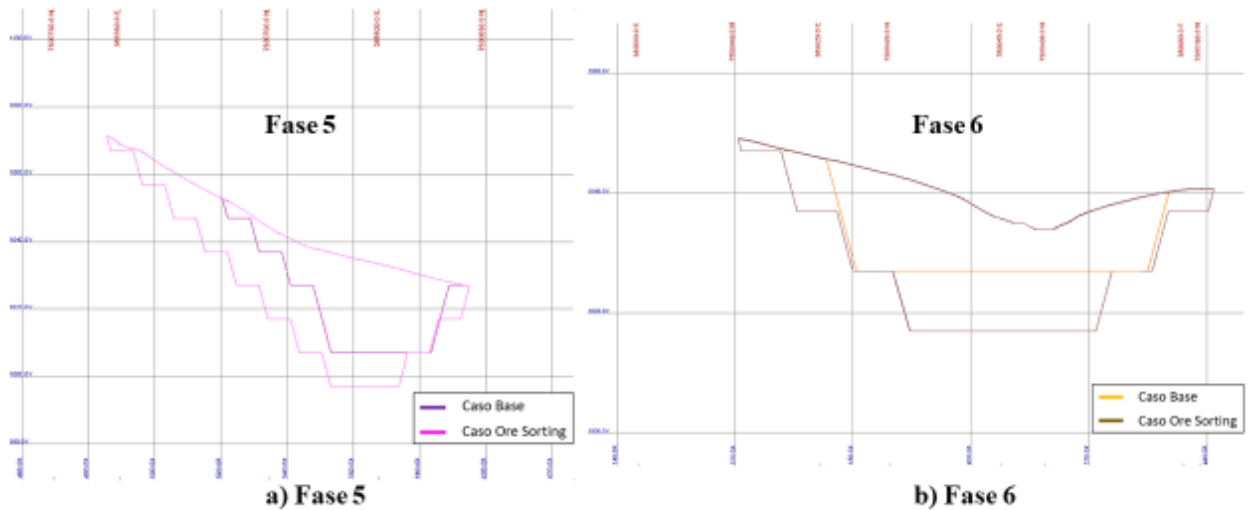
Sección longitudinal. a) Fase 5. b) Fase 6
